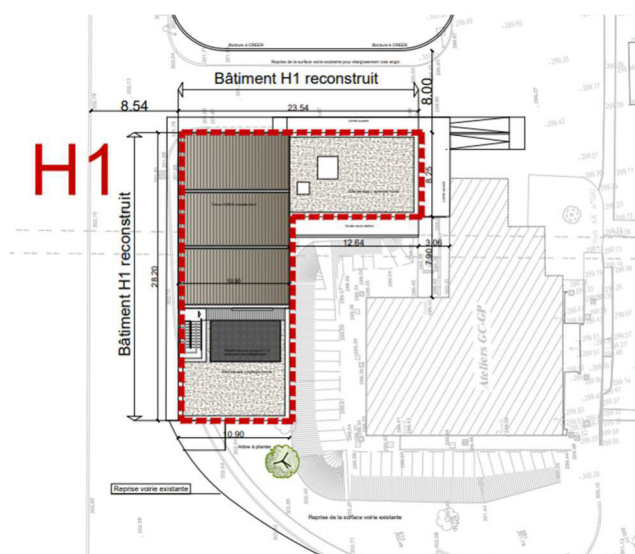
Extrait du plan de masse du projet (source UNIVERSITE DE LORRAINE)
